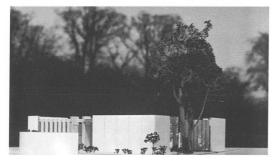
Arne Jacobsen. Casa «Molino», maqueta del prototipo de paneles prefabricados de hormigón, 1969 (Skriver 1969)
